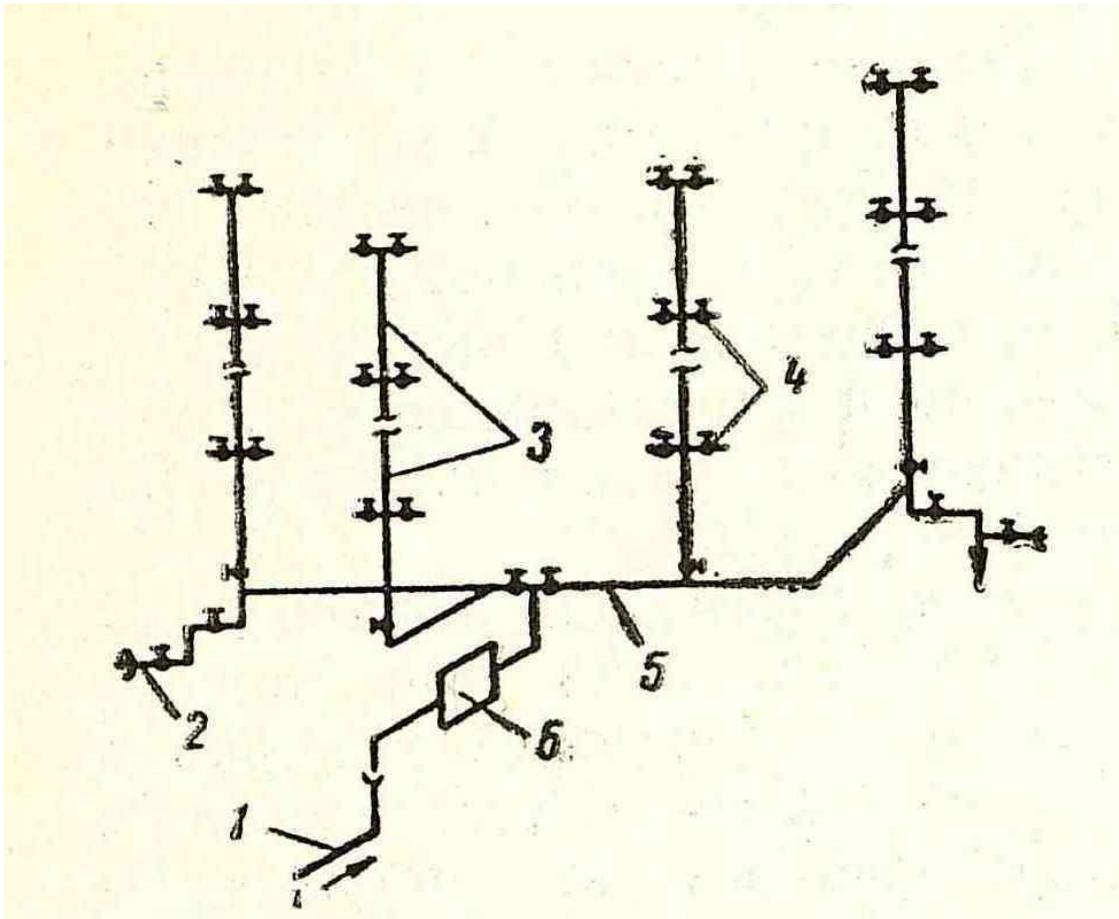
Система водоснабжения здания без напорного бака и повысительной насосной установки:
